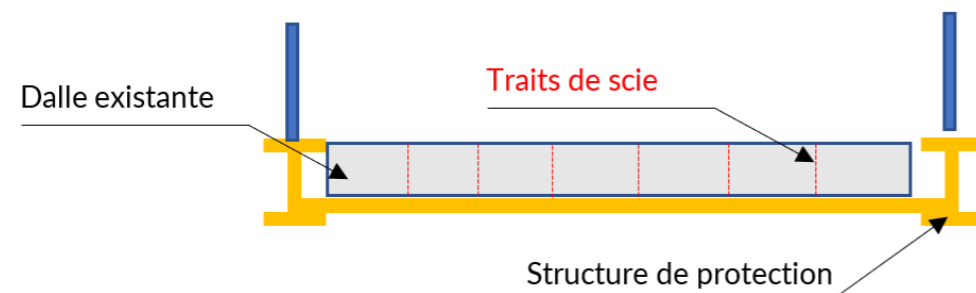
coupe transversale de la structure de protection phase travaux – Variante 1
